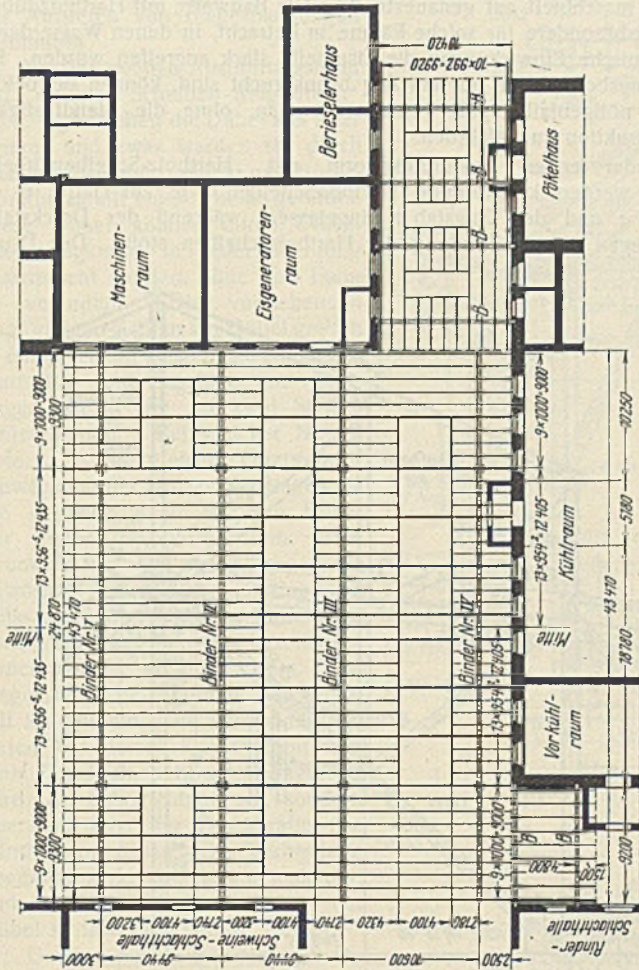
Grundriß der Überdachung des Wagenhalteplatzes im Schlachthof zu Zwickau in Sachsen.
